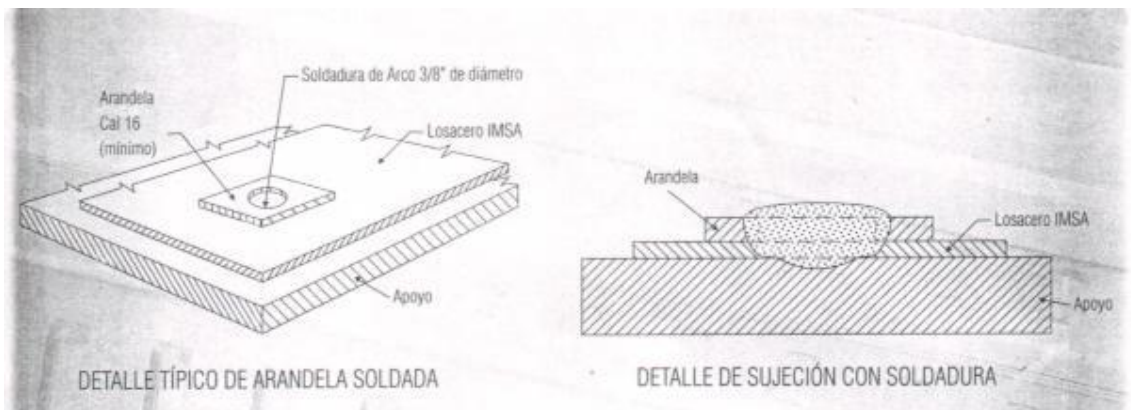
Fijación de la losacero a través de soldadura.
